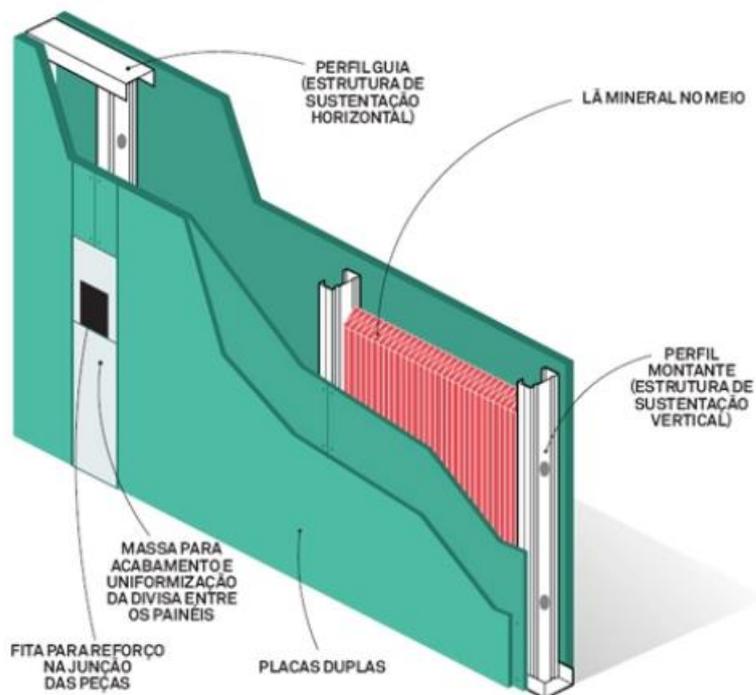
Estruturas do sistema de *drywall*. Fonte: Rodrigues (2014).
